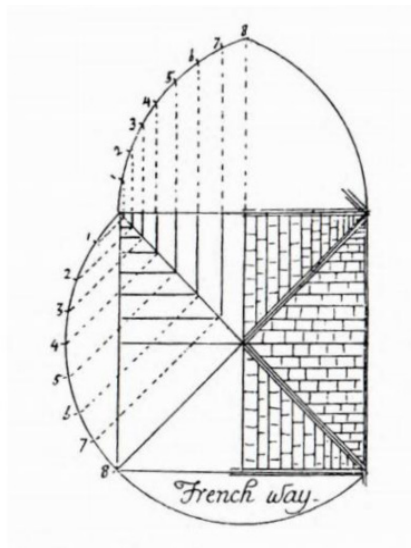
Construcción de la plementería en las bóvedas de crucería (Modelo francés).
